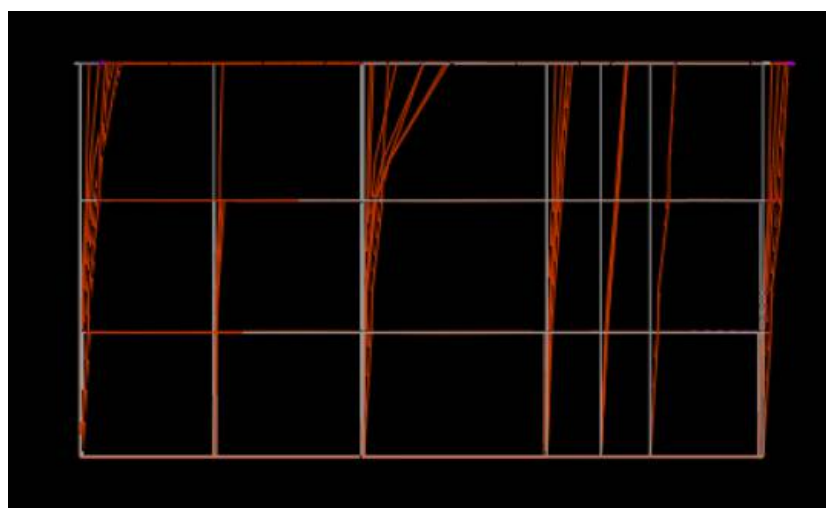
Prospetto - modo di vibrare fondamentale
